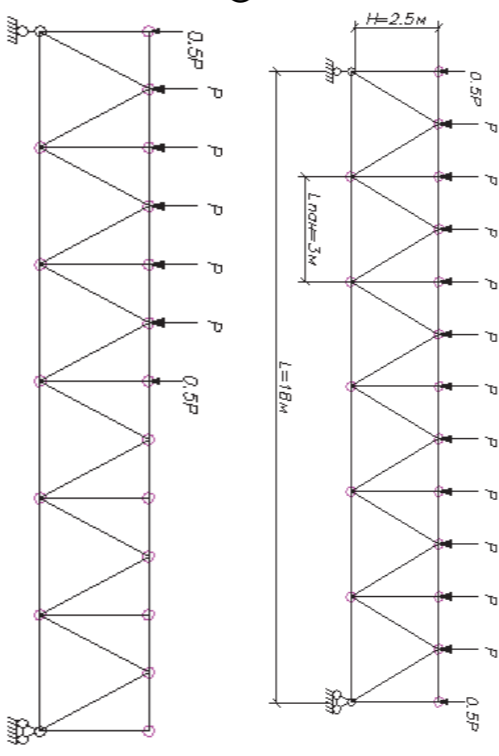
Схема фермы: а – первый вариант нагружения; б – второй вариант нагружения
